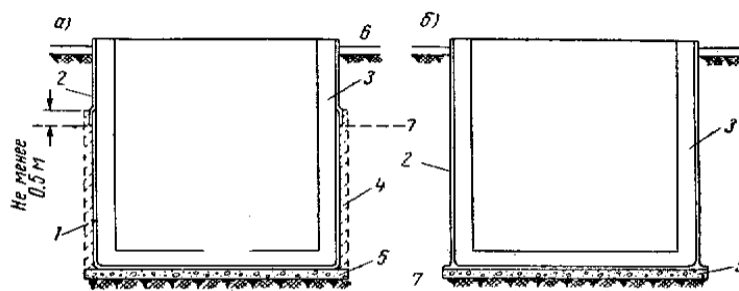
Гидроизоляция заглубленных сооружений.
